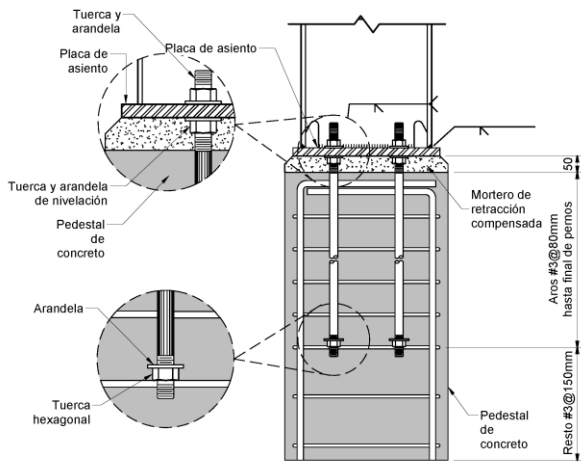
Detalle de conexión de columna metálica a pedestal - Elaboración propia, 2024
